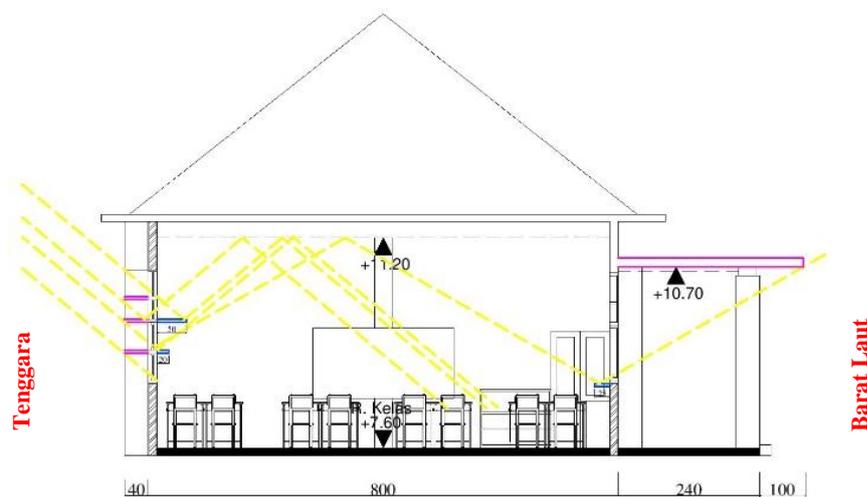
Tampak Tenggara dan Barat Laut Ruang Alternatif 3 Rekomendasi Eksternal-Internal Ruang Kelas IPA
